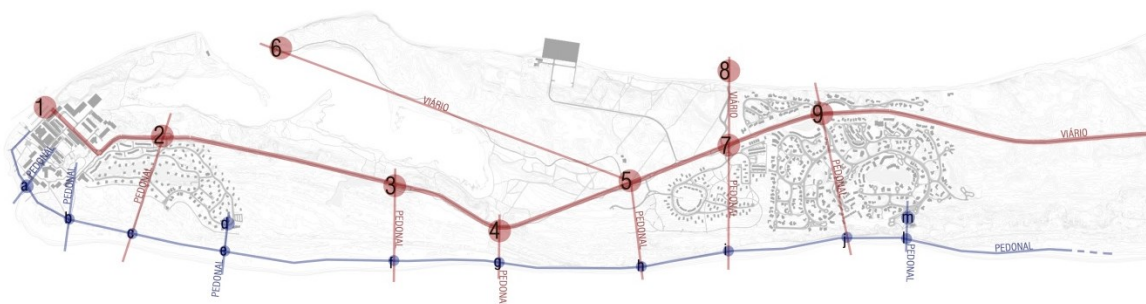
Planta esquemática da intervenção geral: eixos e nós de articulação. Fonte: autoria própria.
